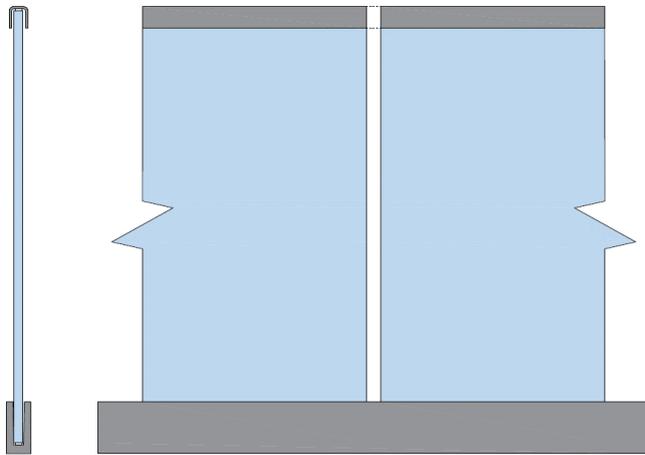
Sistema α : Versión con pasamanos conectado sin conexión entre los paneles
